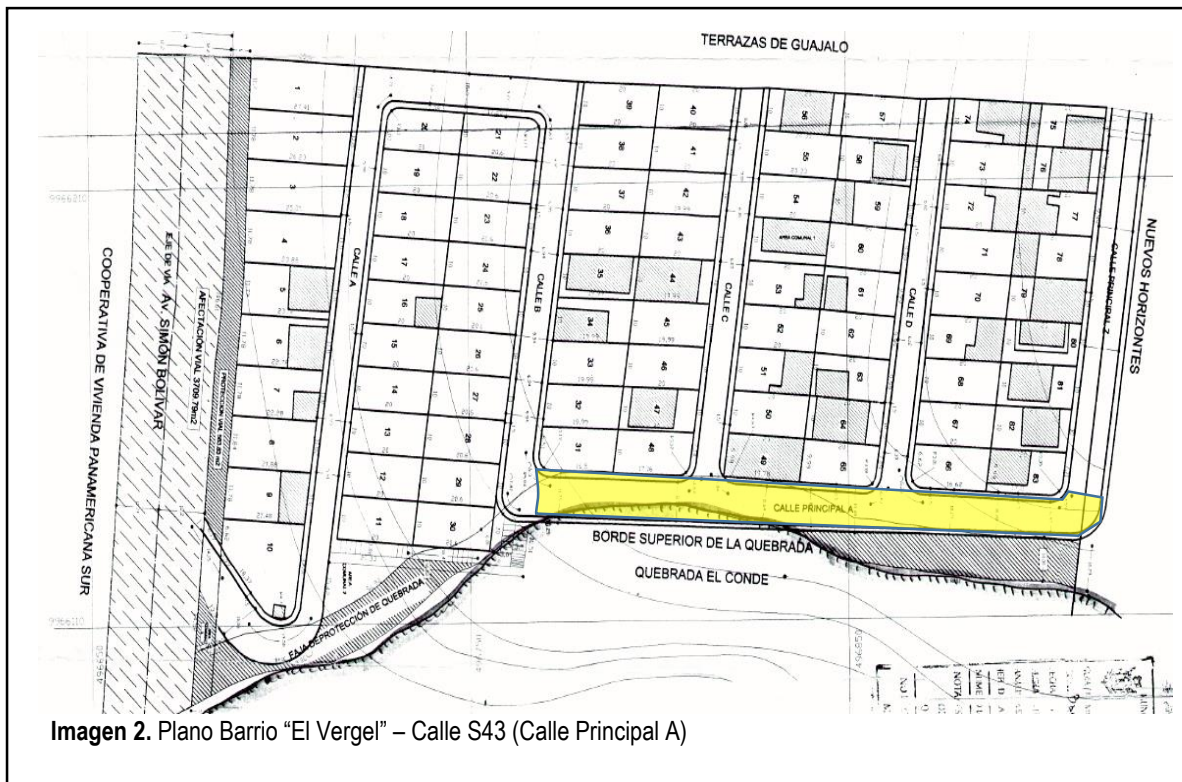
Plano Barrio “El Vergel” – Calle S43 (Calle Principal A)
